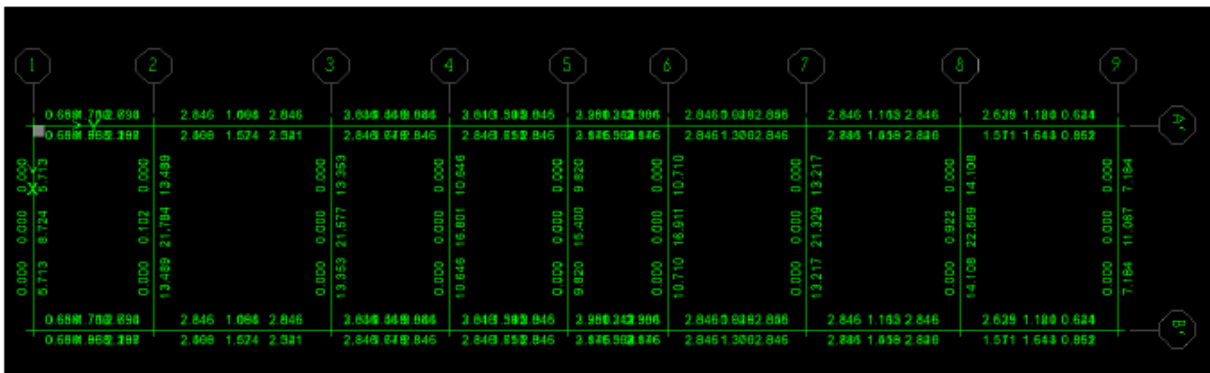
Área de acero de refuerzo en vigas Segundo Techo (cm²)
